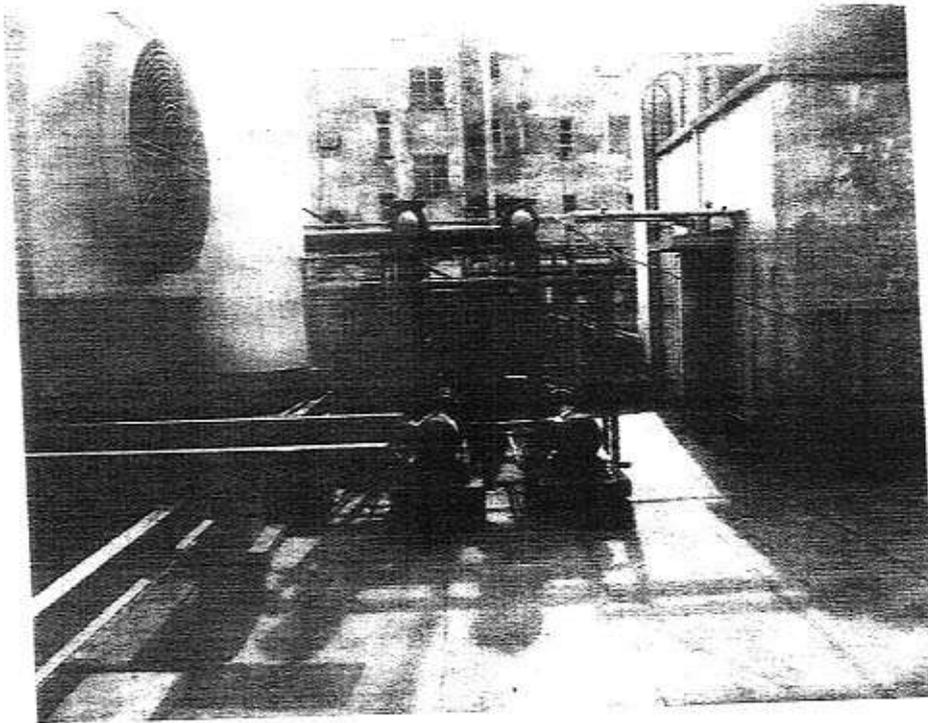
Vista de bombas y parte de cañerías de terraza a reemplazar.
